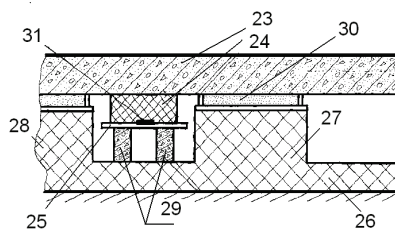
Схема виброизоляции железобетонной плиты в основании здания.
